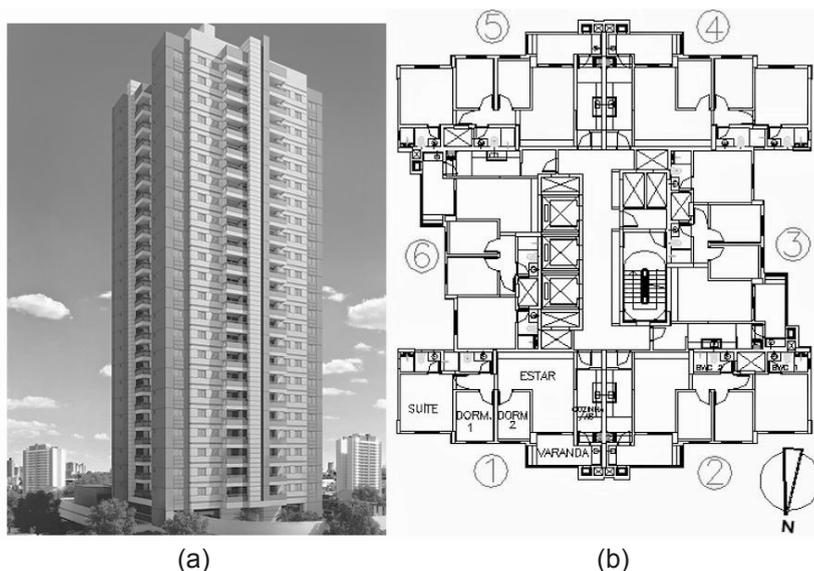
(a) Edifício residencial analisado (b) Planta baixa do pavimento tipo com a numeração das unidades habitacionais
